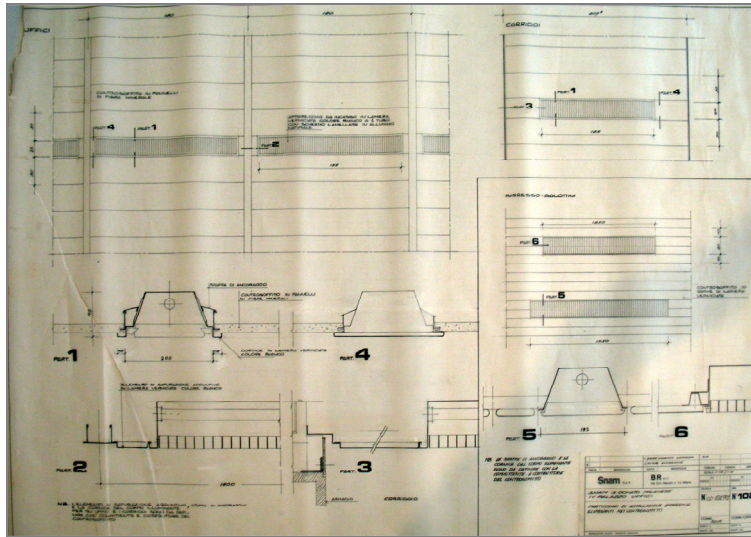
installazione apparecchi illuminanti - particolare (fonte CSAC – tav. 102, archivio n. 384-2)
